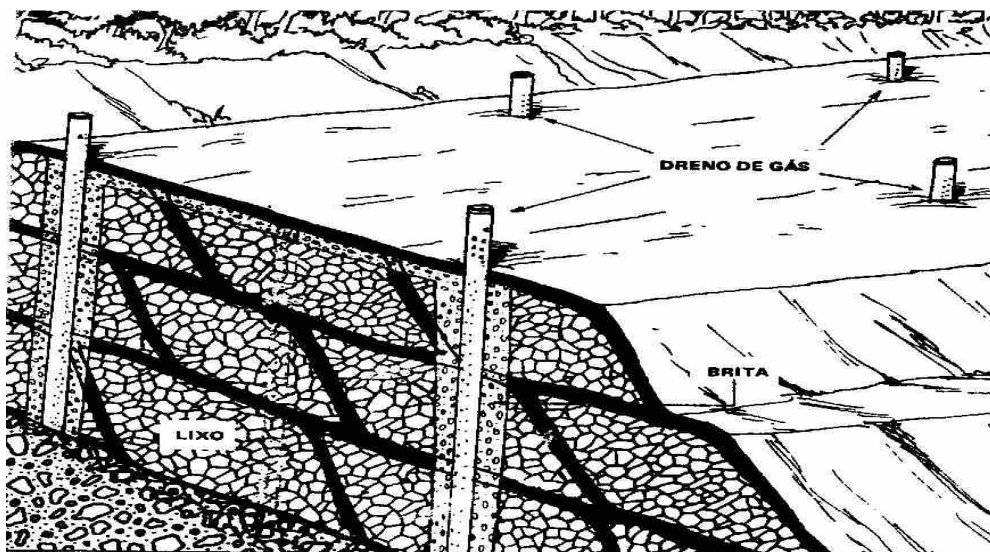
Sistema de Drenagem de Gás a ser Implantado no Aterro
